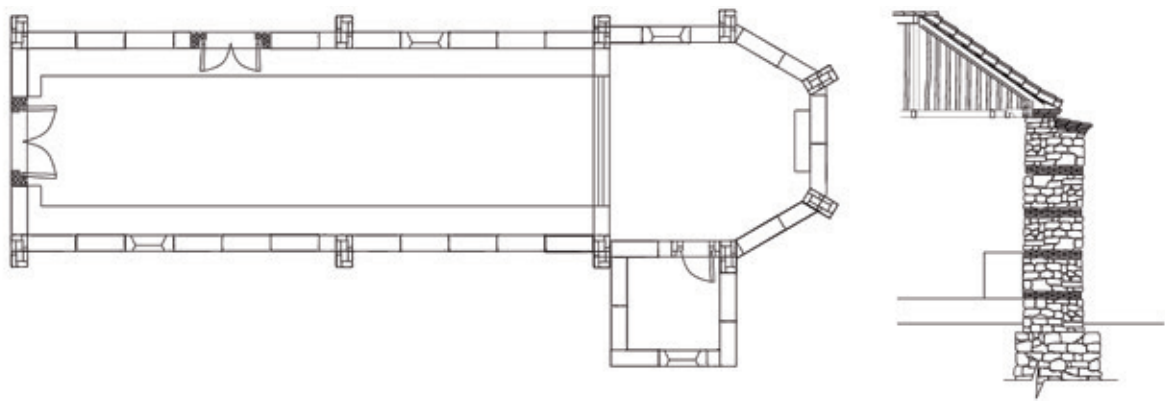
Planos de la iglesia de Tocancipá, construida en tapia con rafas, verdugadas y contrafuertes de ladrillo. Planta general y corte del muro testero²⁷.
